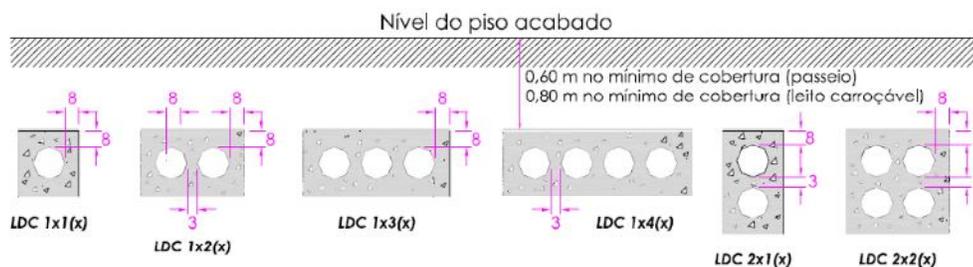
Detalhe do envolvimento de eletroduto PVC em concreto.
